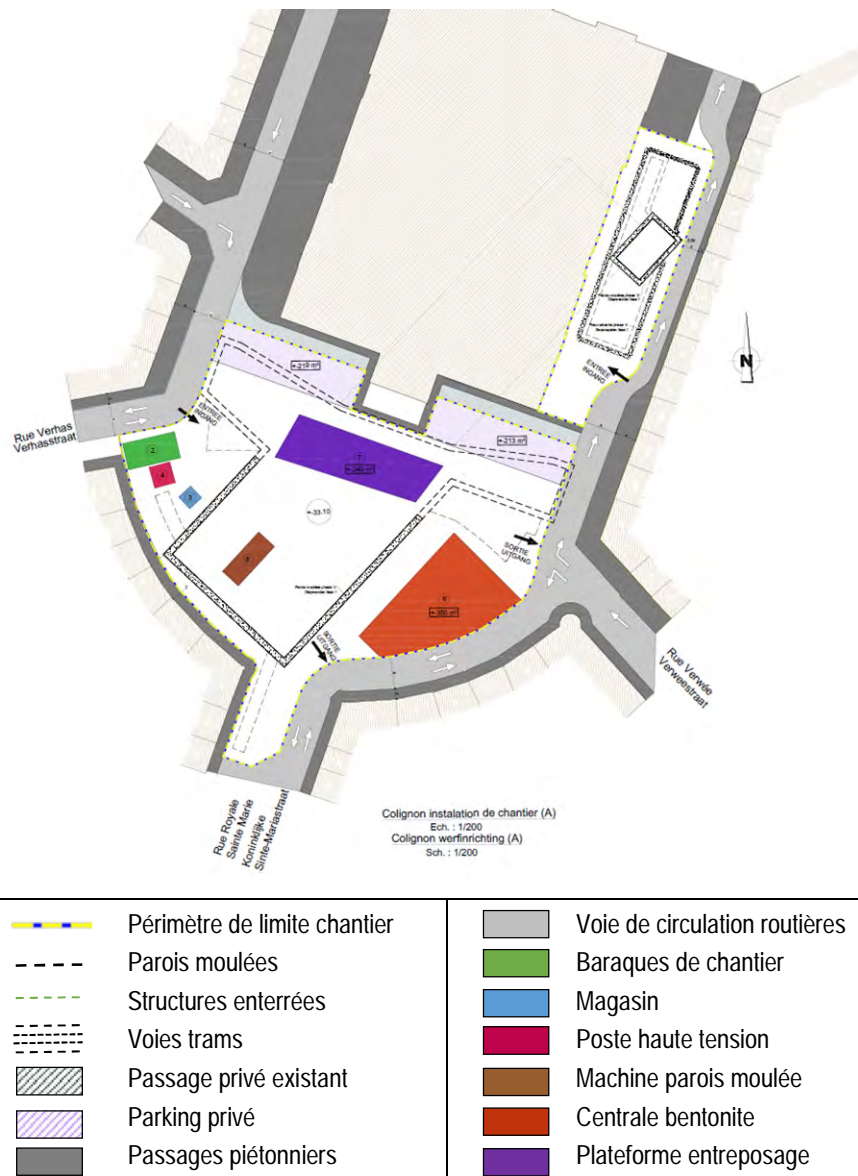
Plan de la phase A des installations de chantier (BMN, 2019)
